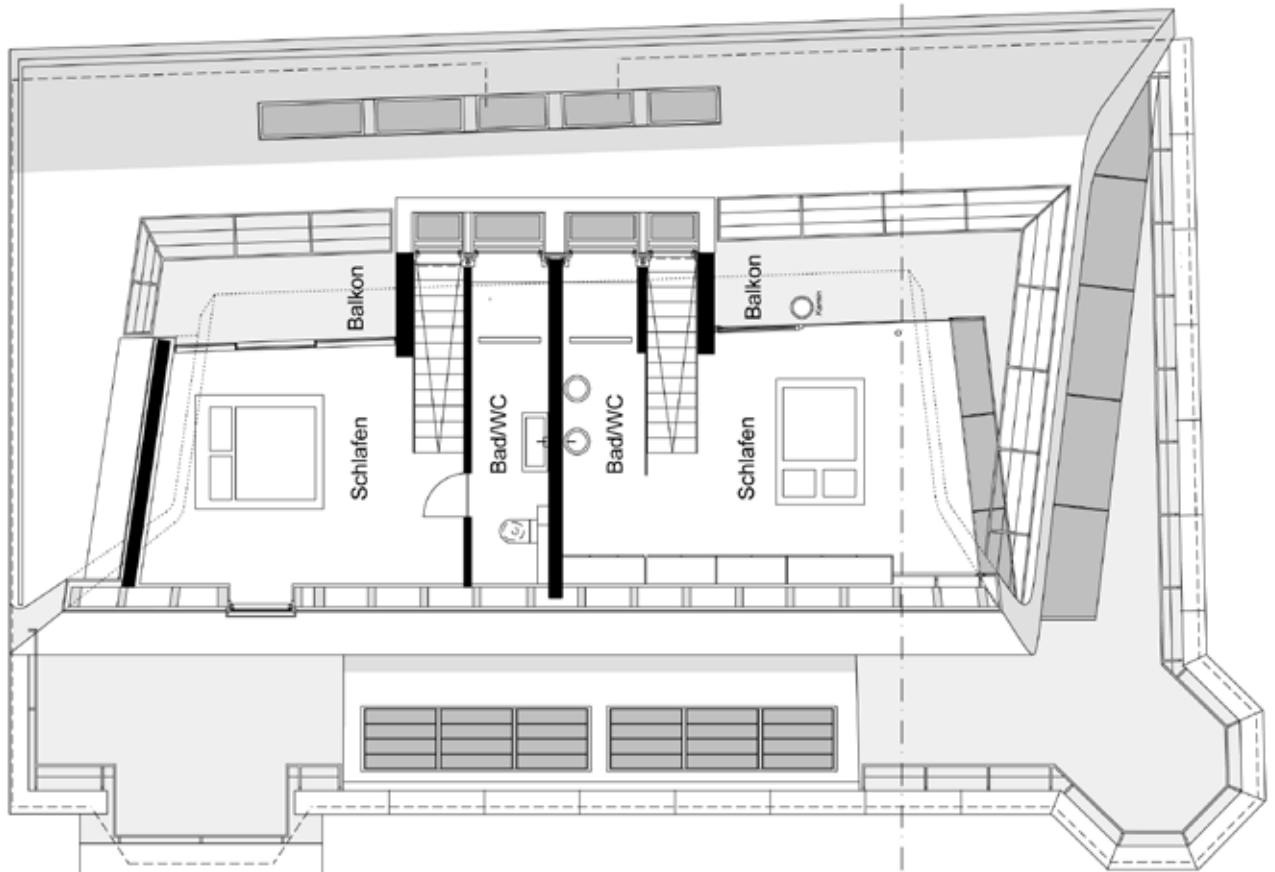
\_ Grundriss 2.DG © Danner Yildiz
